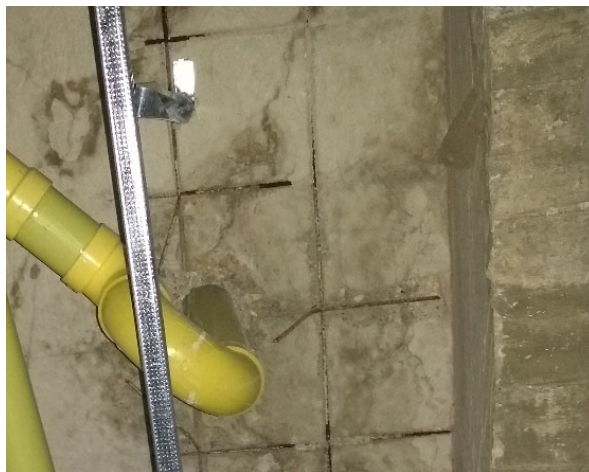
Corrosión y oxidación en acero de la losa.
